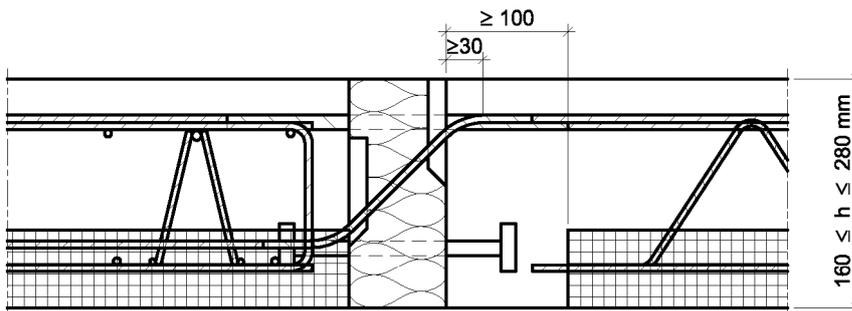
Beispiel Schöck Isokorb Typ K bzw. KF mit Elementplatten
